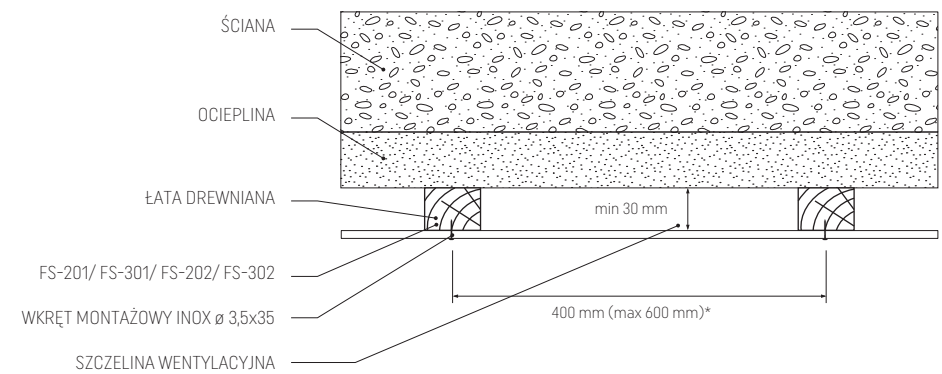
Szczelina wentylacyjna, montaż na murze – przekrój poziomy
